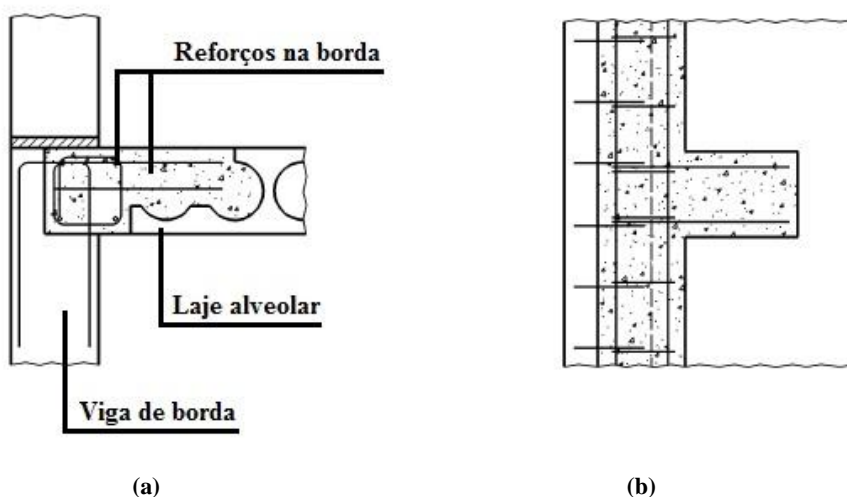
15 – Tipo de ligação do pavimento com a interface lateral: (a) Corte transversal das lajes; (b) Vista em planta da região (BASEADO: BS EN1168, 2005).
